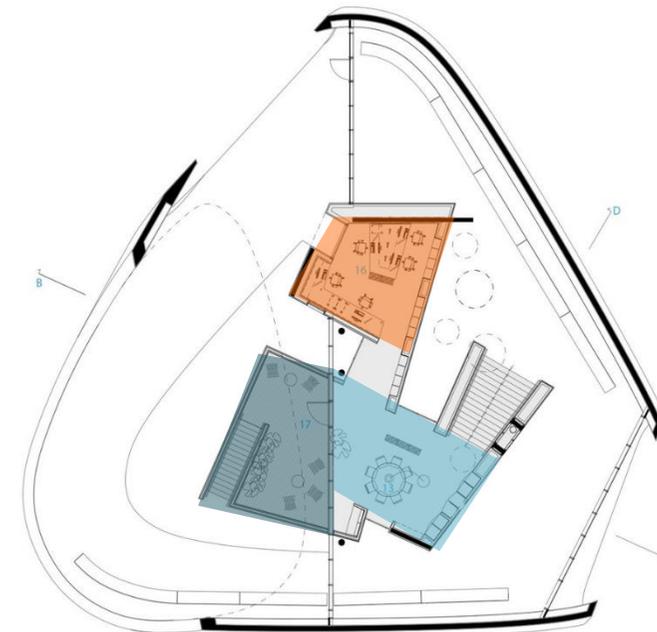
Planta Baixa do segundo pavimento Fonte : Archdaily (2019)
